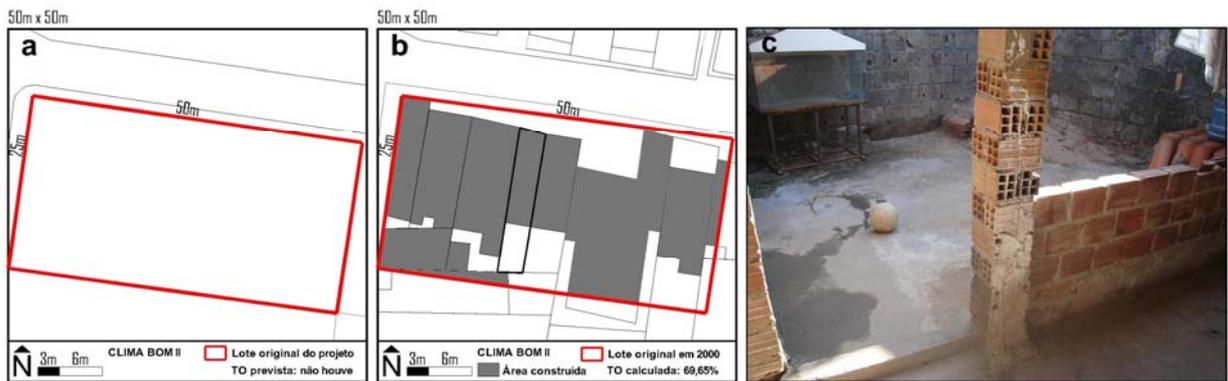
(a) Lote original do loteamento Clima Bom II; (b) Lote da amostra com grande área construída; (c) Quintal 100% impermeabilizado do lote destacado em preto na figura (b).
